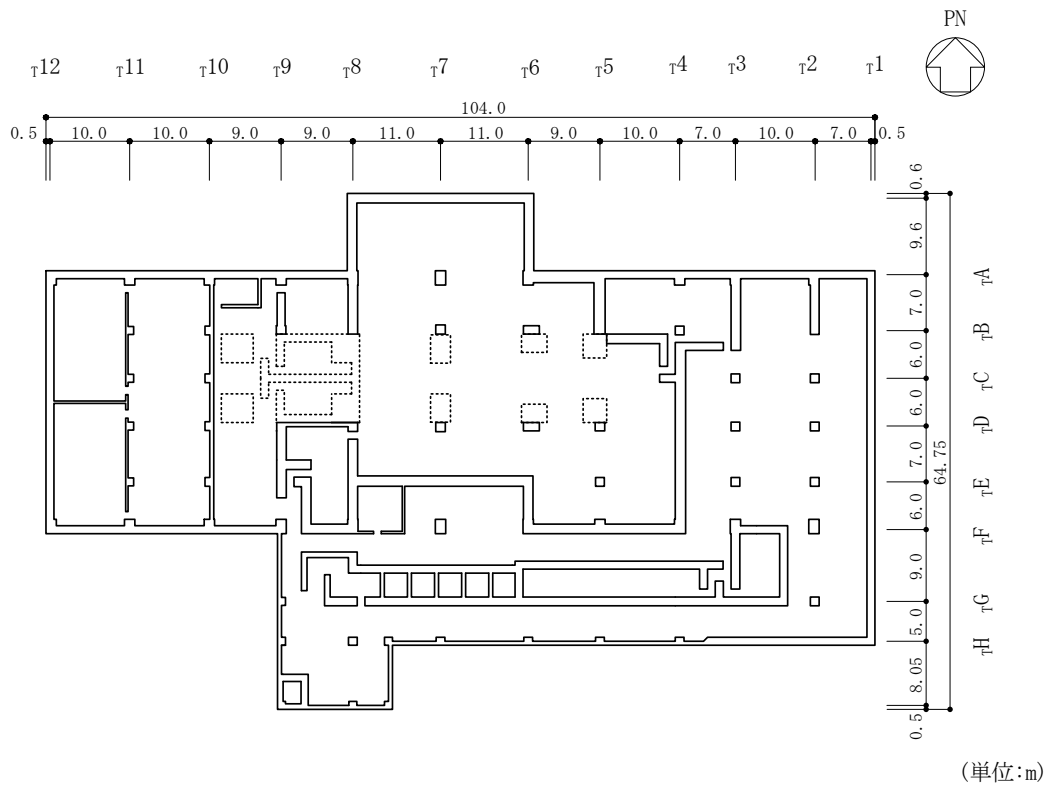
1号機タービン建物の概略平面図 (EL 1.8m*)
